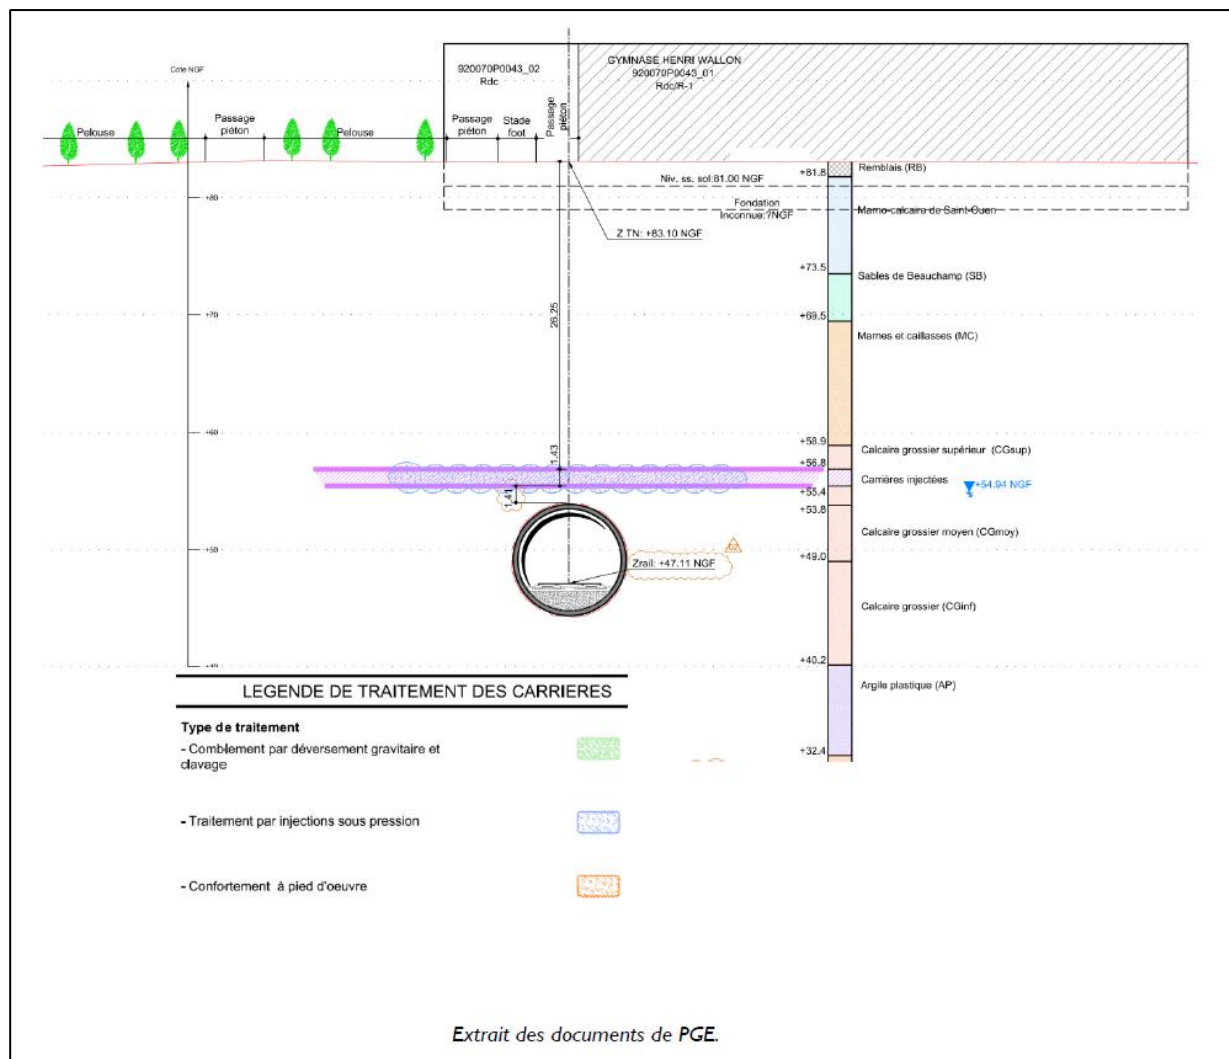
Coupe utilisée pour le positionnement du tunnel.
